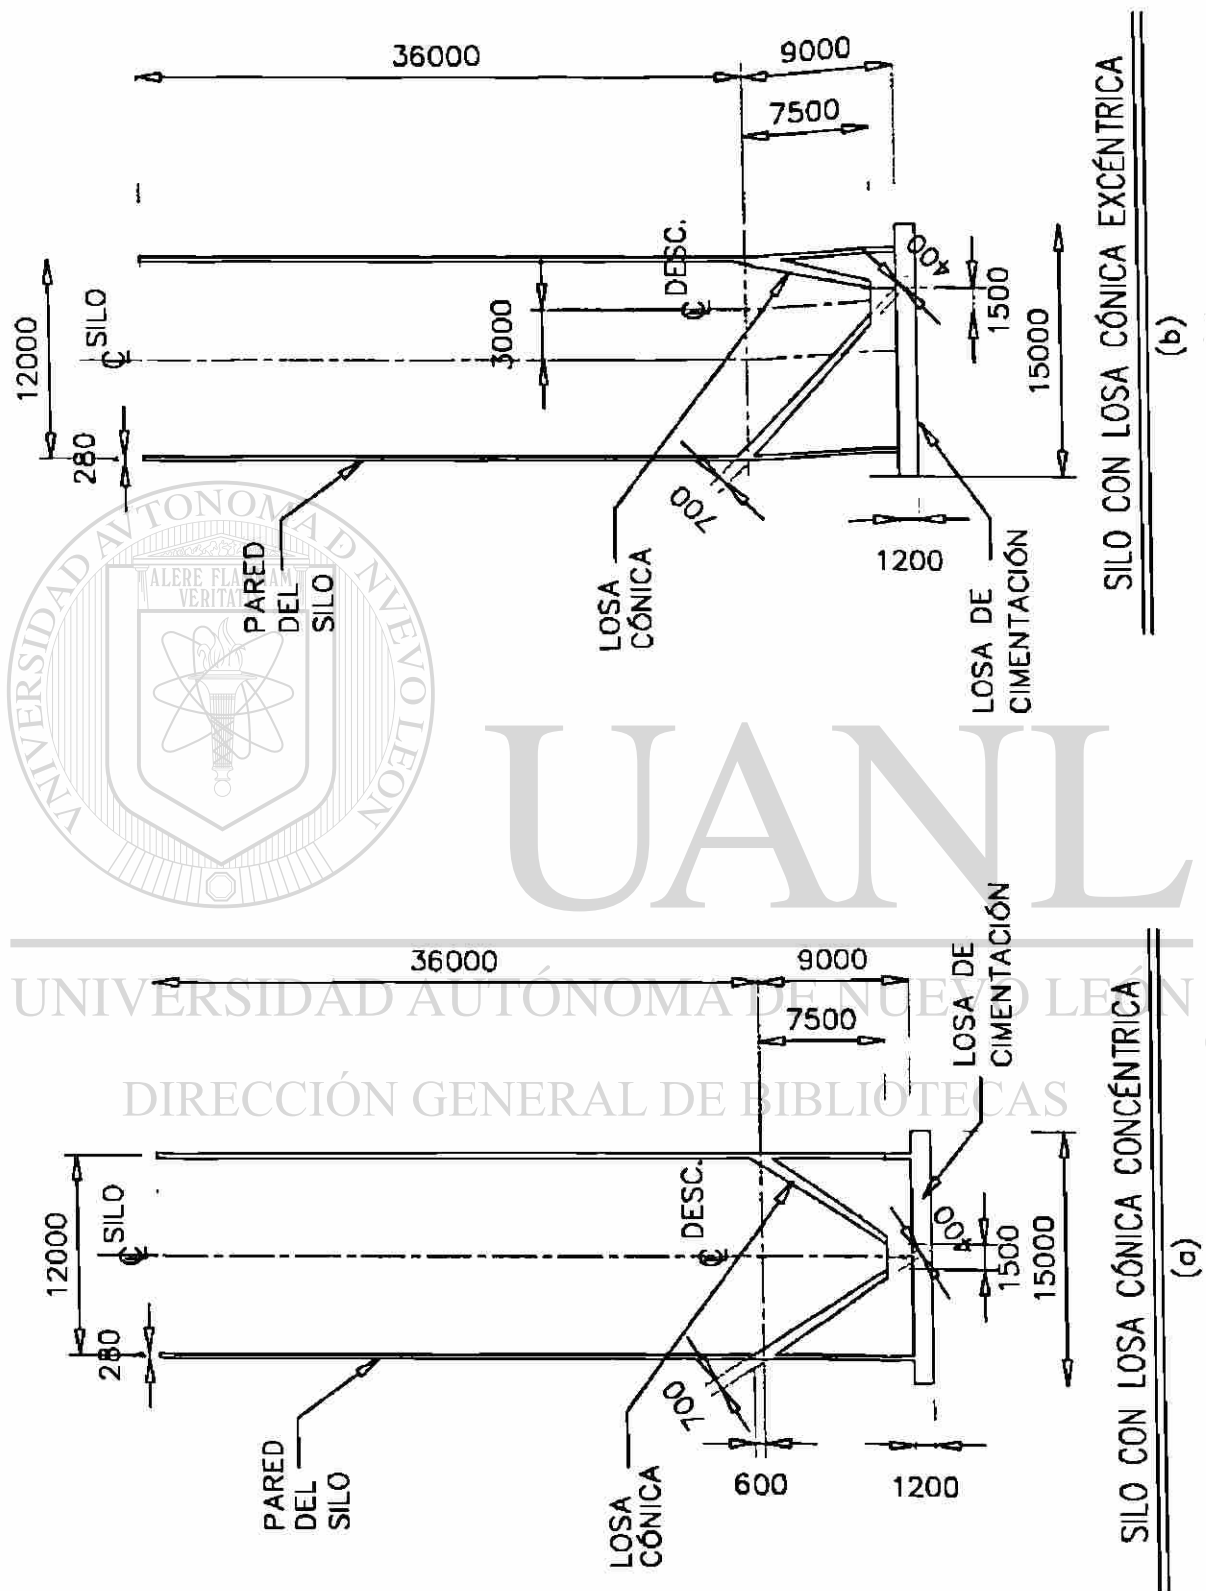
Modelos estructurales de silos con losa de fondo cónica.
